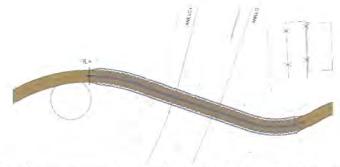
Vista en planta primera propuesta arquitectónica y estructural en el cruce de Anillo Periférico.
